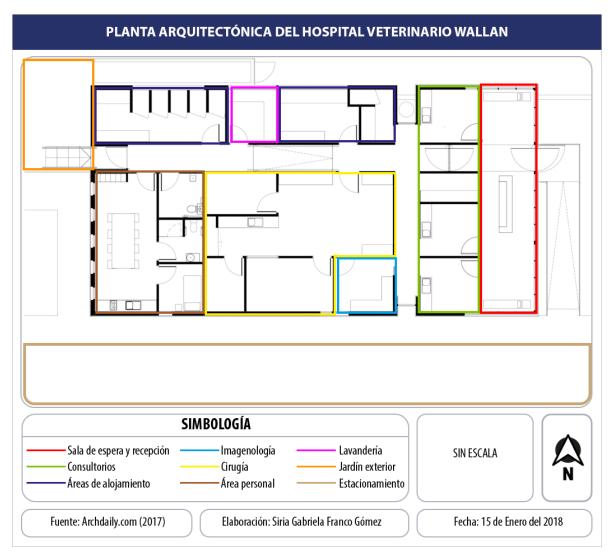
Planta arquitectónica del Hospital Veterinario Wallan. Fuente: (Archdaily, 2017)
